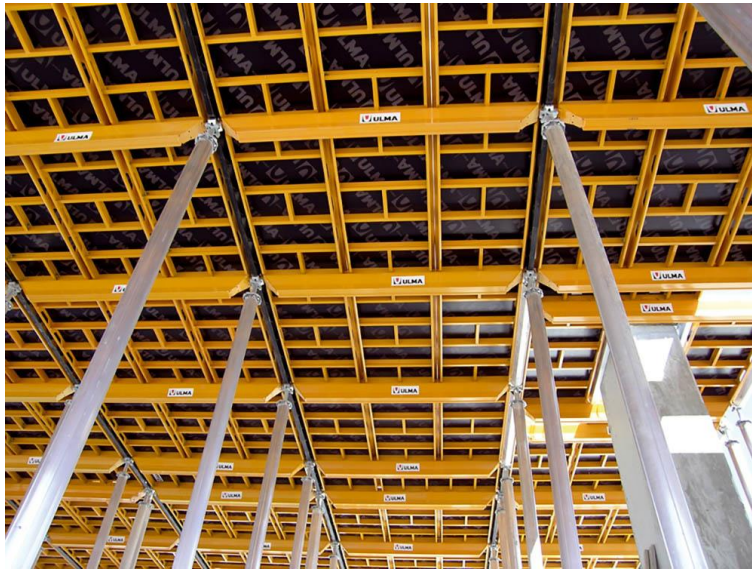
Sistema ULMA de cofragem em alumínio para lajes maciças em betão [9]
